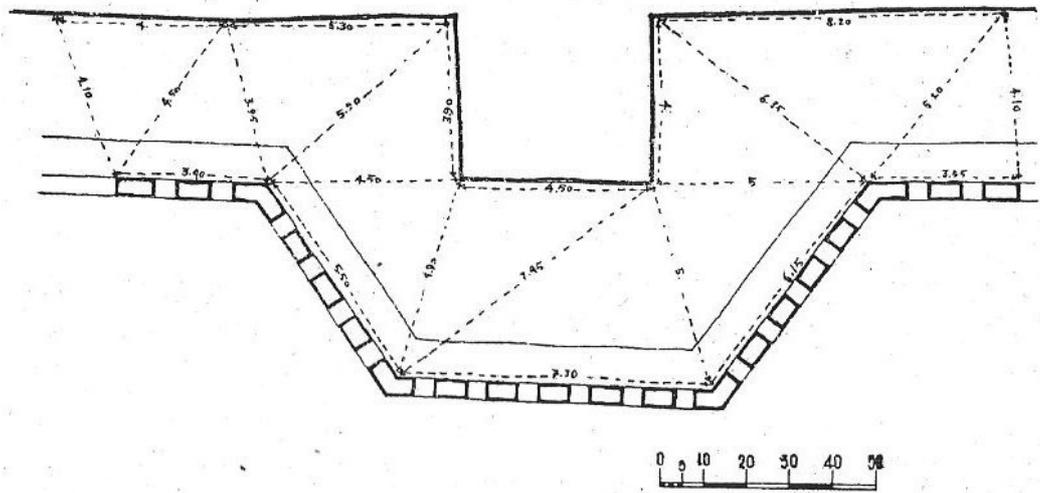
Doppelmauer von Sevilla, Ausschnitt Grundriss
